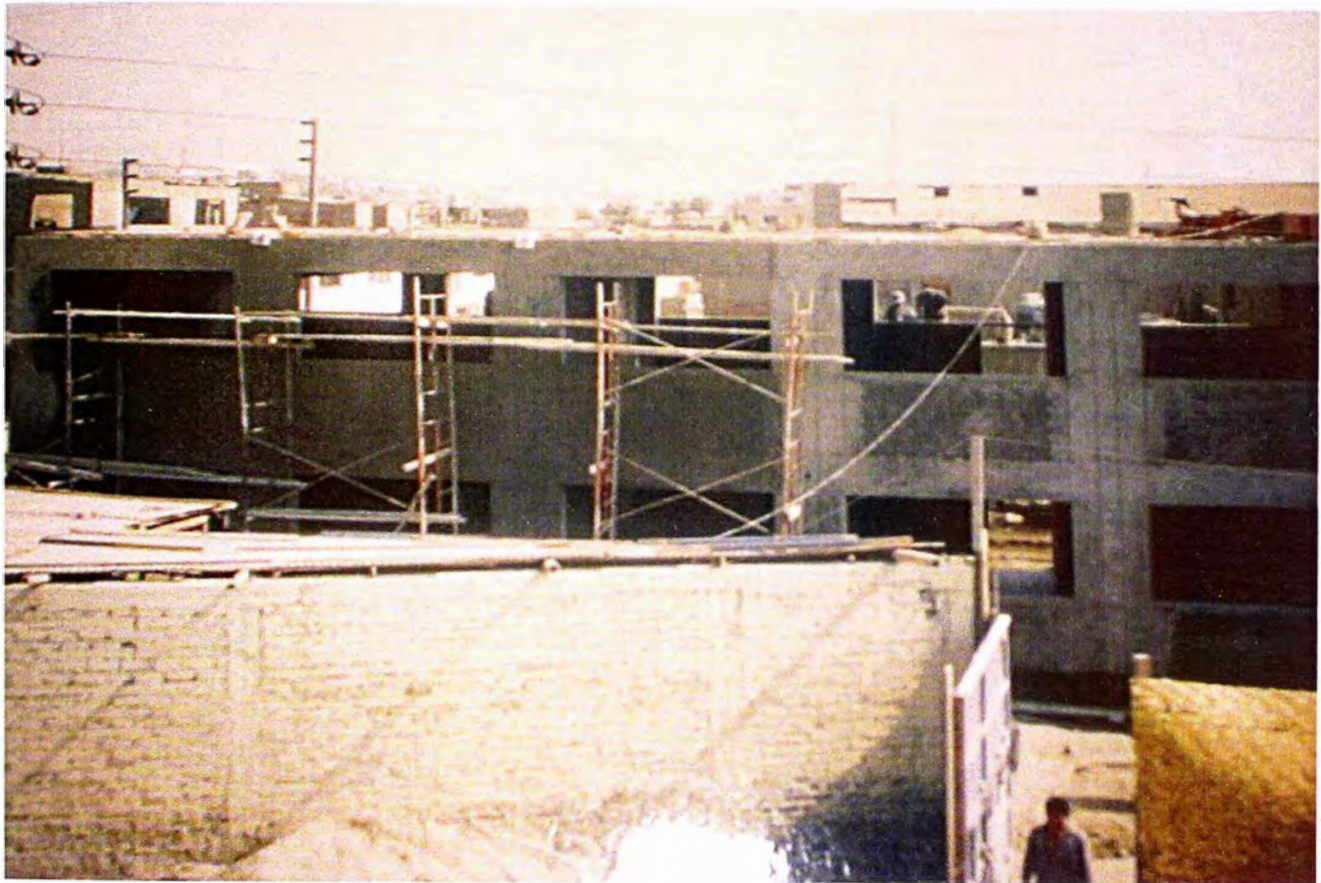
VISTA LATERAL DE MUROS EXTERIORES TARRAJEADOS
